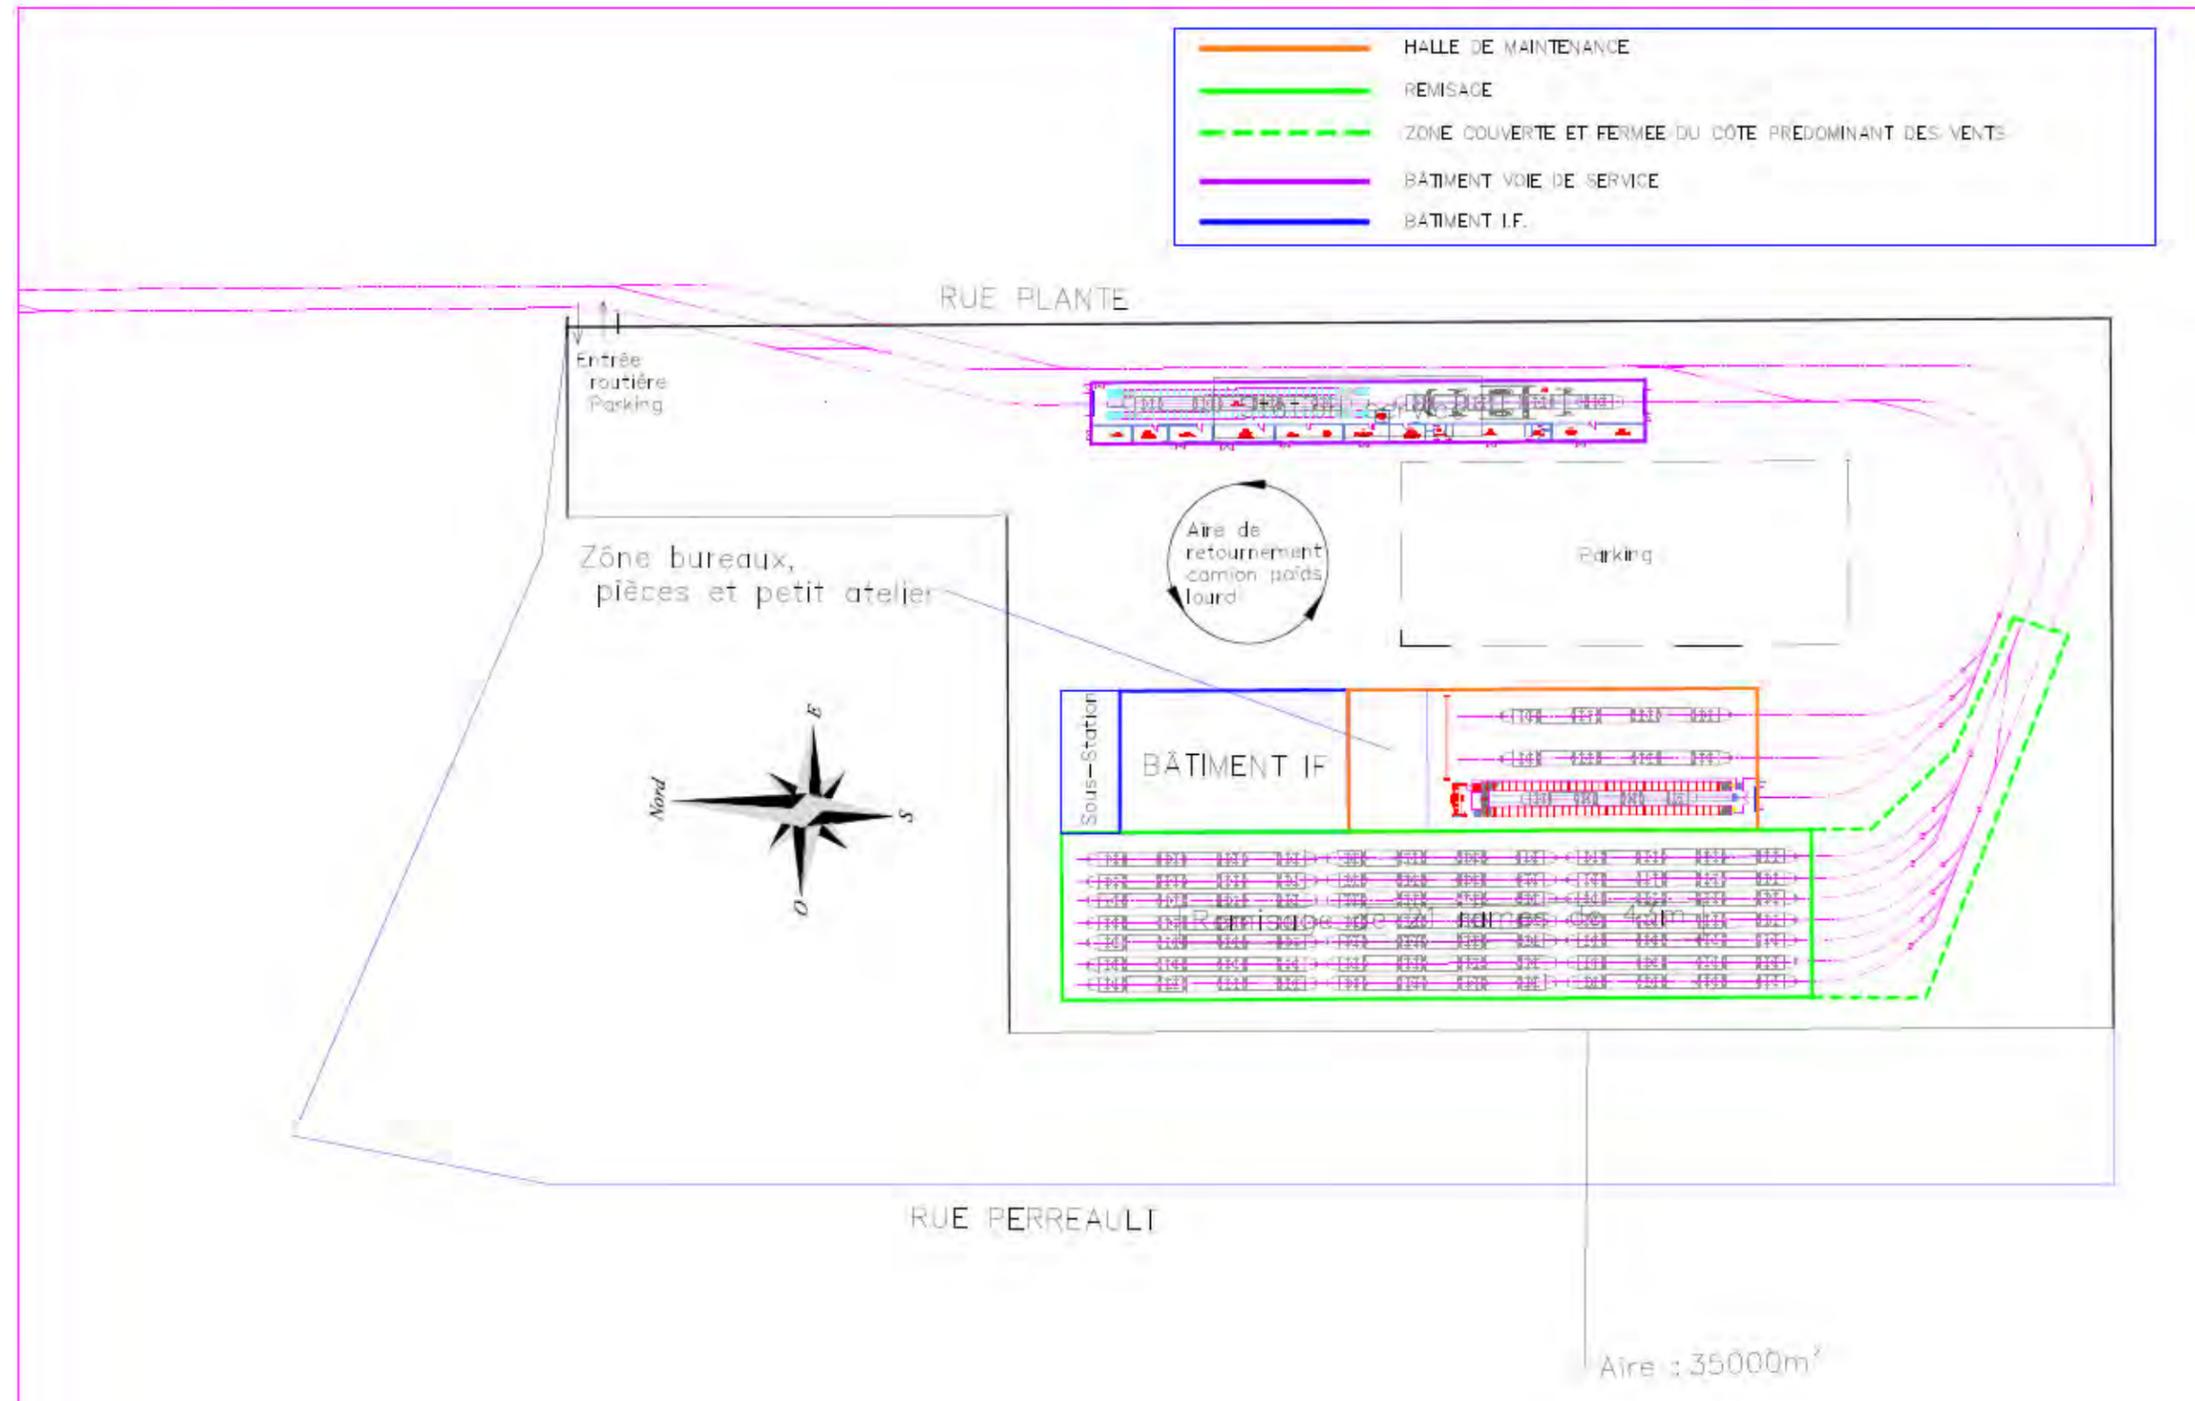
Plan masse CEE secondaire – rue Plante, Lévis
